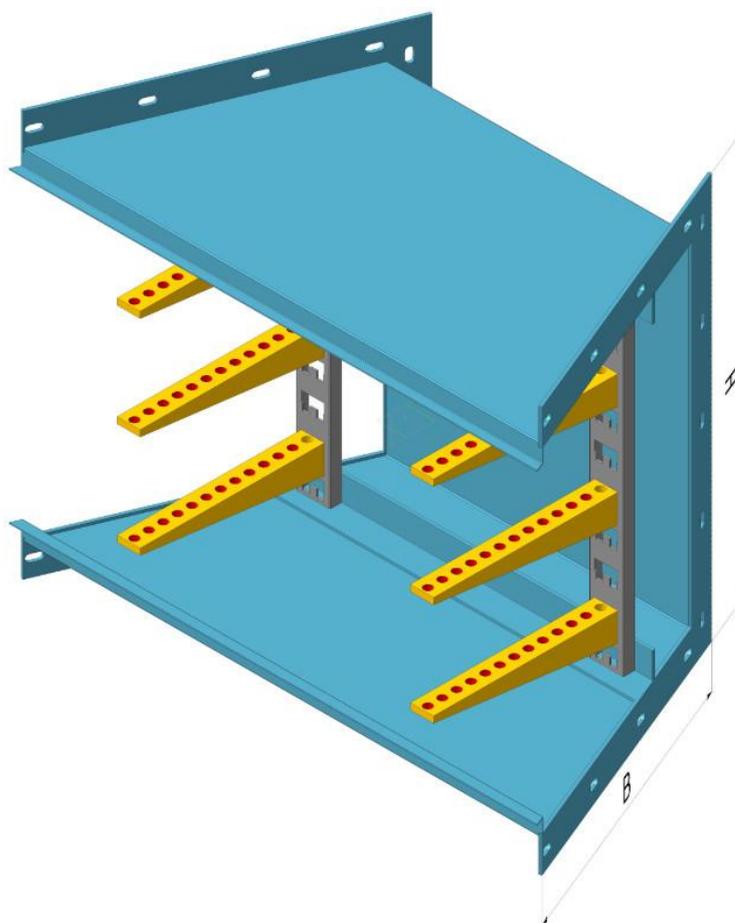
Короб кабельный блочный с наружным углом поворота типа ККБ-УГН. Общий вид
